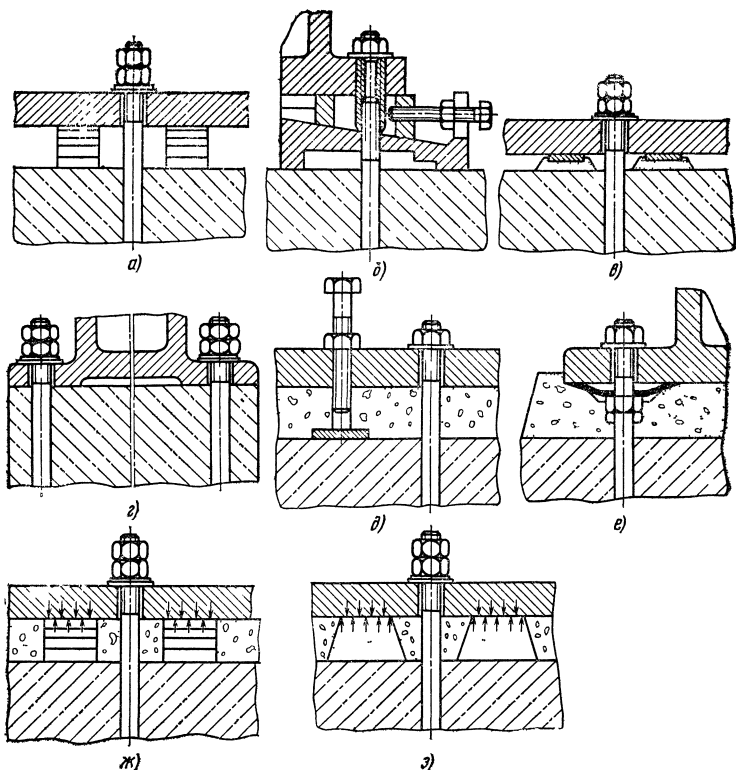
Основные конструкции стыка корпусная деталь — фундамент: с местным опиранием на пакеты подкладок (а), на опорные башмаки (б), на бетонные опоры (в) и непосредственно на фундамент (г); со сплошным опиранием на бетонную подливку с временной установкой при выверке на отжимных вингах (д) и на установочных гайках (е); со смешанным опиранием на подливку и опорные элементы (ж и з)
